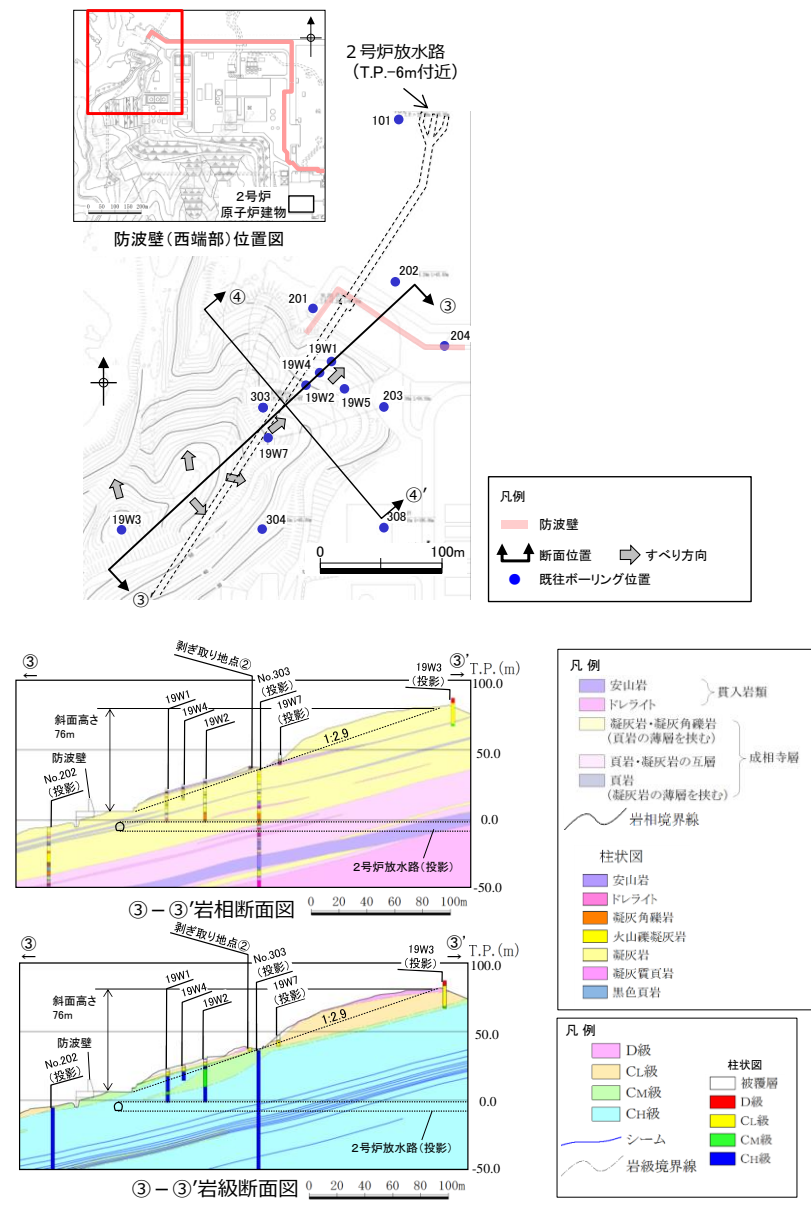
(1) 防波壁(西端部) 地質断面図・岩級断面図
